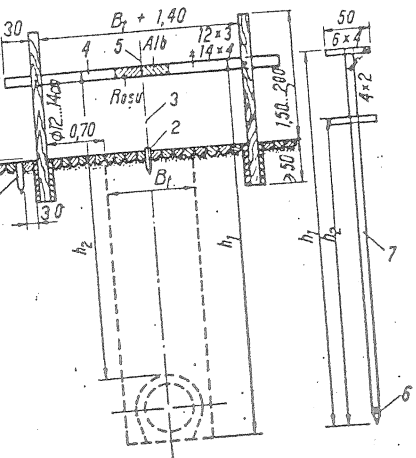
Construcție auxiliară necesară execuției canalelor:
